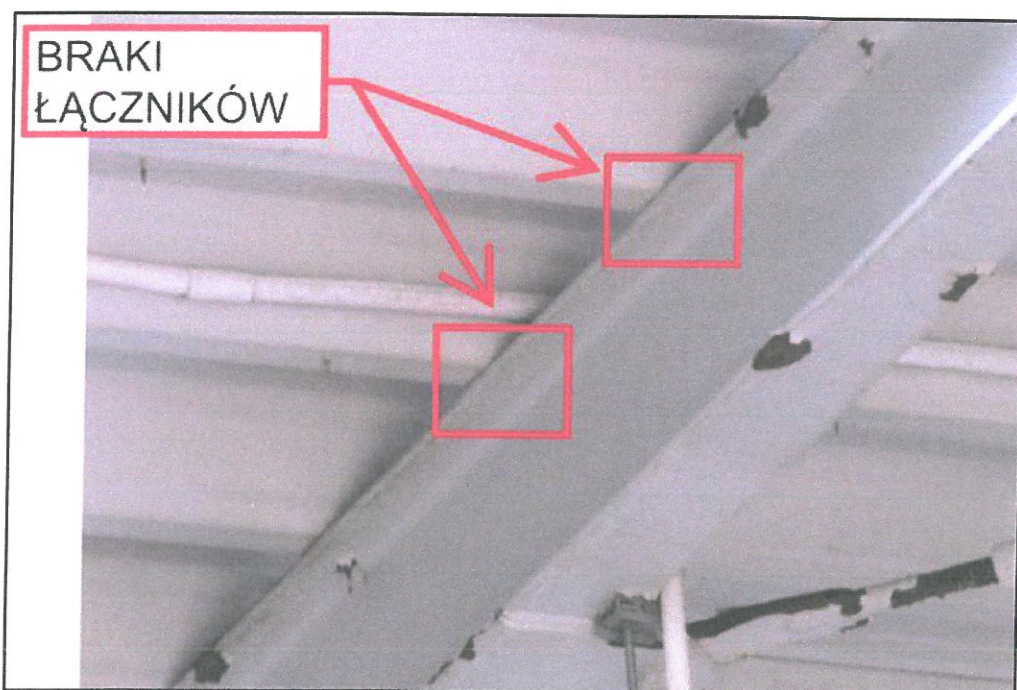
Korozja miejscowa na powierzchni rygli dachowych.
